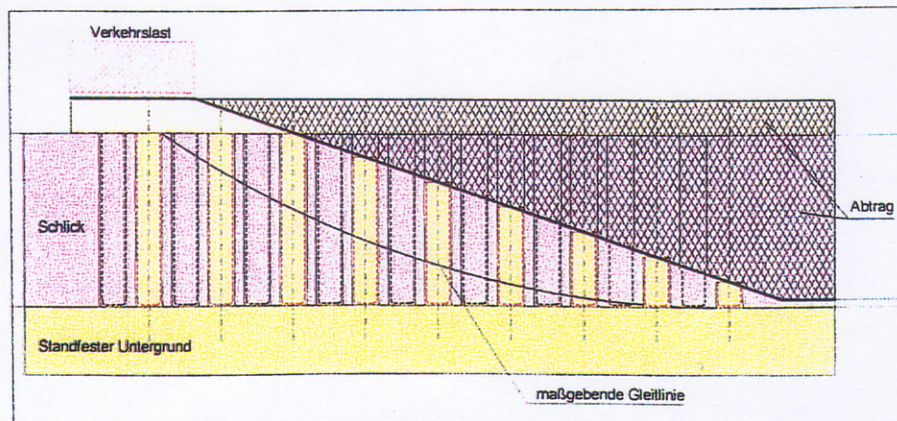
Stabilisierung einer instabilen Abtragschöpfung
